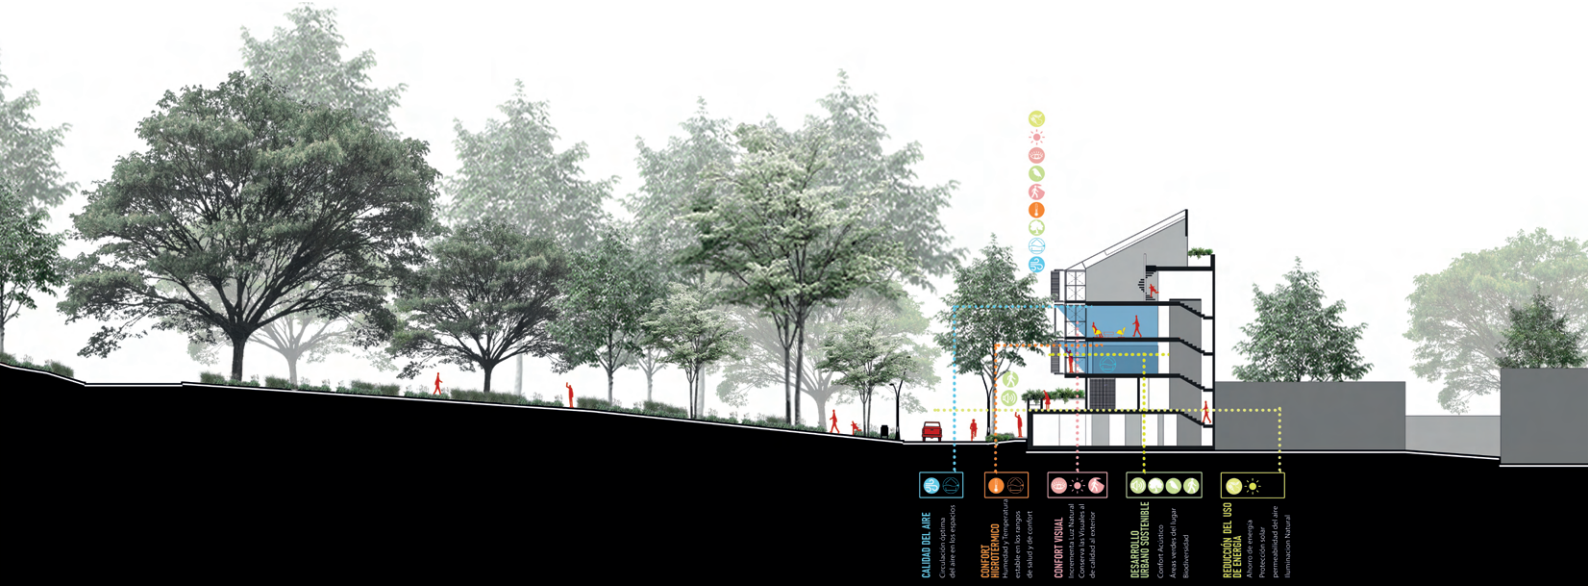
Edificio O'Byrne Corte por fachada con intervención en el sistema de fachada.
